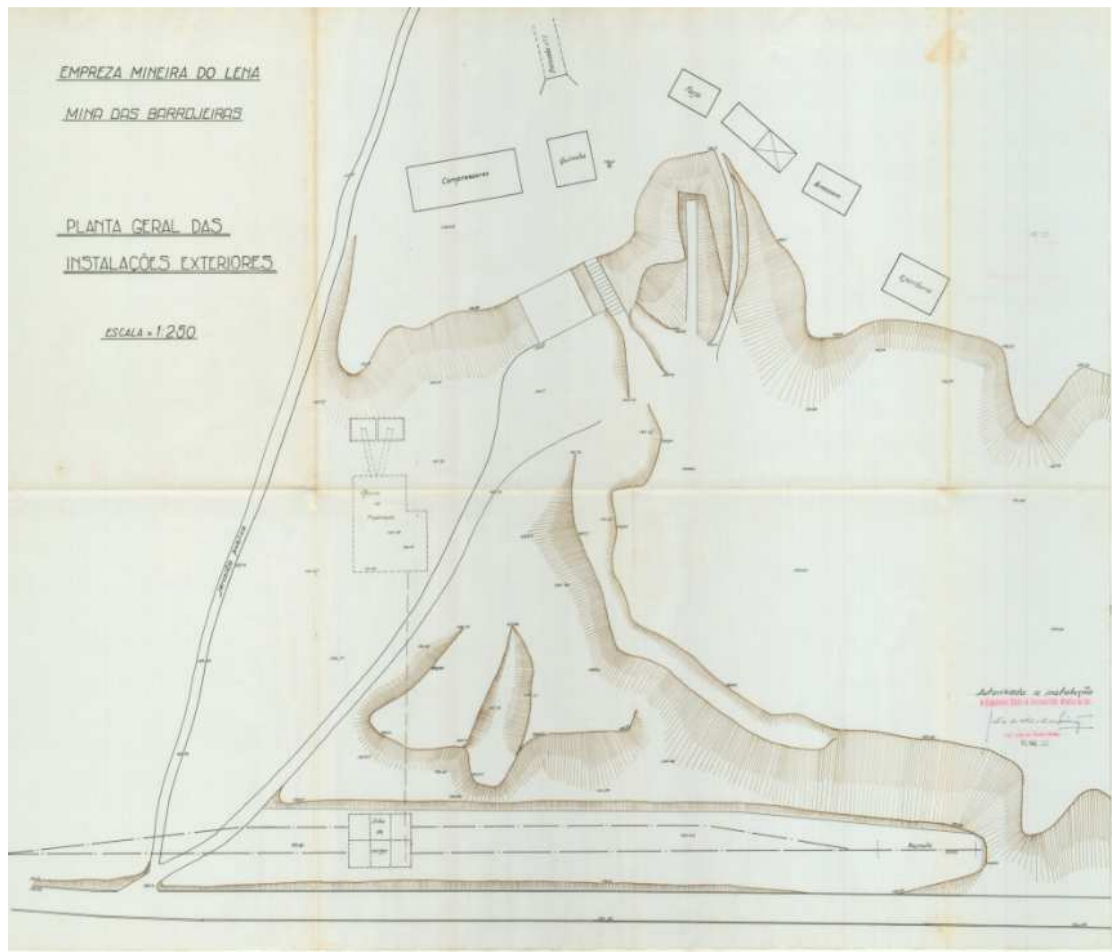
Planta das instalações nas Barrojeiras (Alcanadas). A tracejado assinala-se a projetada oficina de escolha mecânica construída em 1941 e o tegão carregador dos vagões de caminho de ferro . Cortesia AHDGEG / LNEG.
